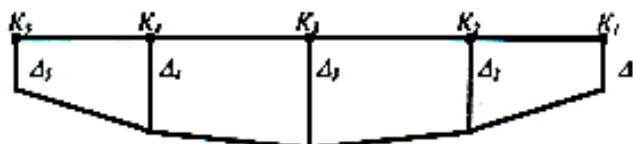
Эпюра перемещений верхних концов колонн каркаса при легкой кровле.
